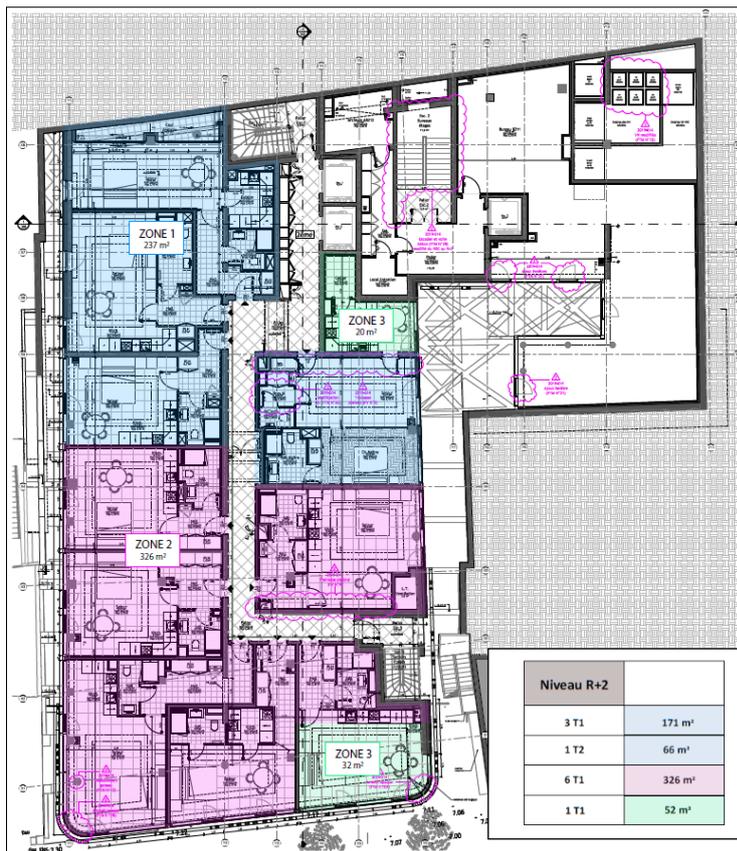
Divisione delle aree di lavoro del secondo piano (R+2)
